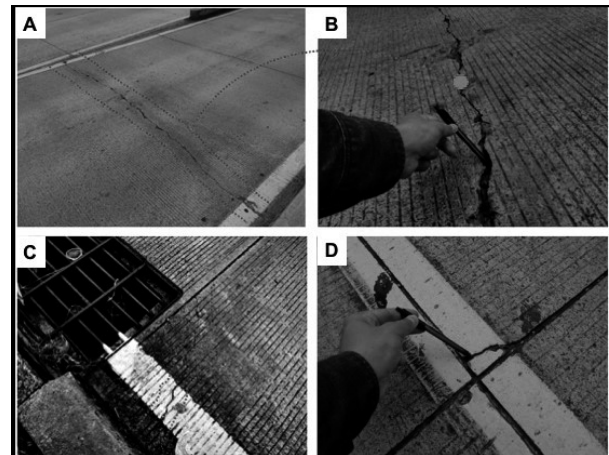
Presencia de grietas en zonas de análisis (A-B Grieta transversal y C-D Grietas en bordes). Fuente: Elaboración propia (2020).
